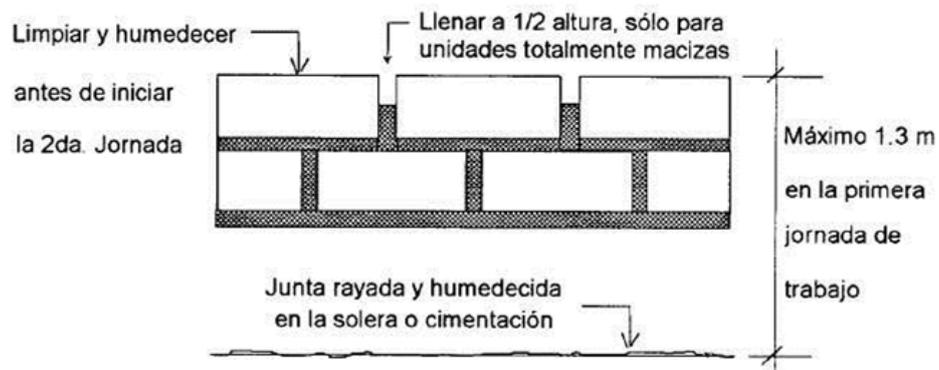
Especificaciones de asentado en muro de albañilería o mampostería [50].
